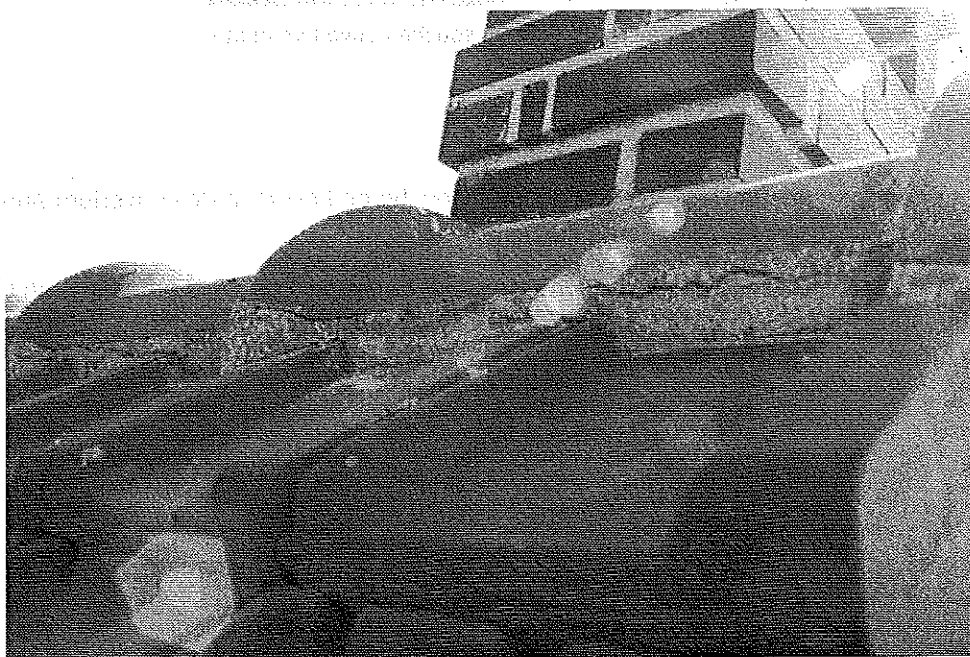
Détail jonction faîtage-souche ; importance fissuration du mortier de pose.
